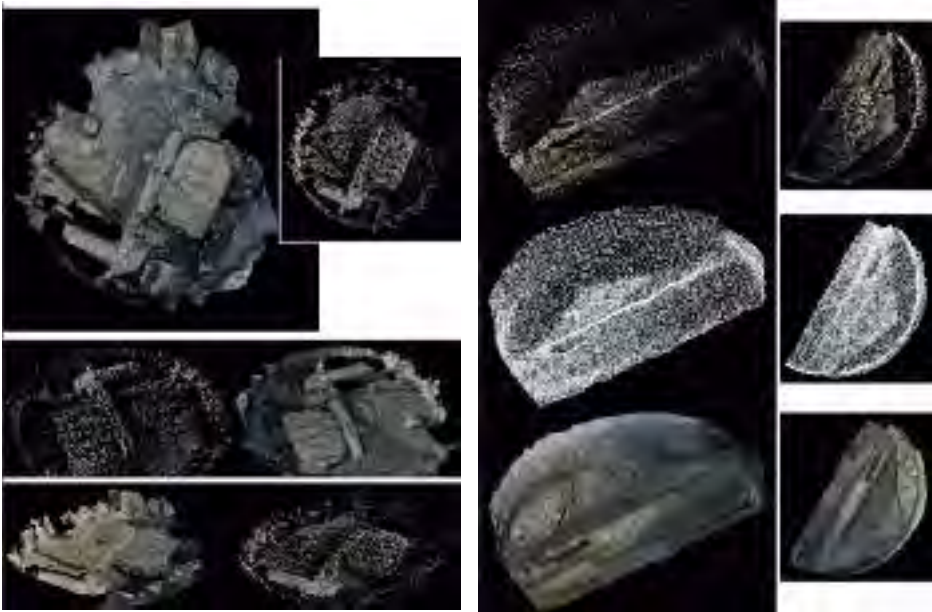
Fotogrametría, excavación Fase 1 Plataforma.
